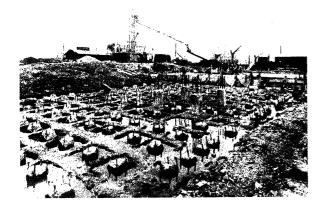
Hormigón Fondu pilotes prefabricados (1931).
